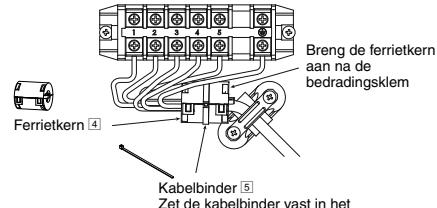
DETAIL VAN GELEIDING VAN AANSLUITKABEL
